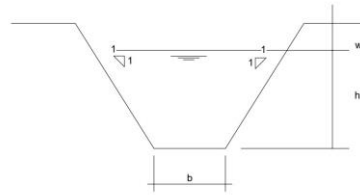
Perencanaan dimensi saluran Tipe Drain (Box Culvert)
